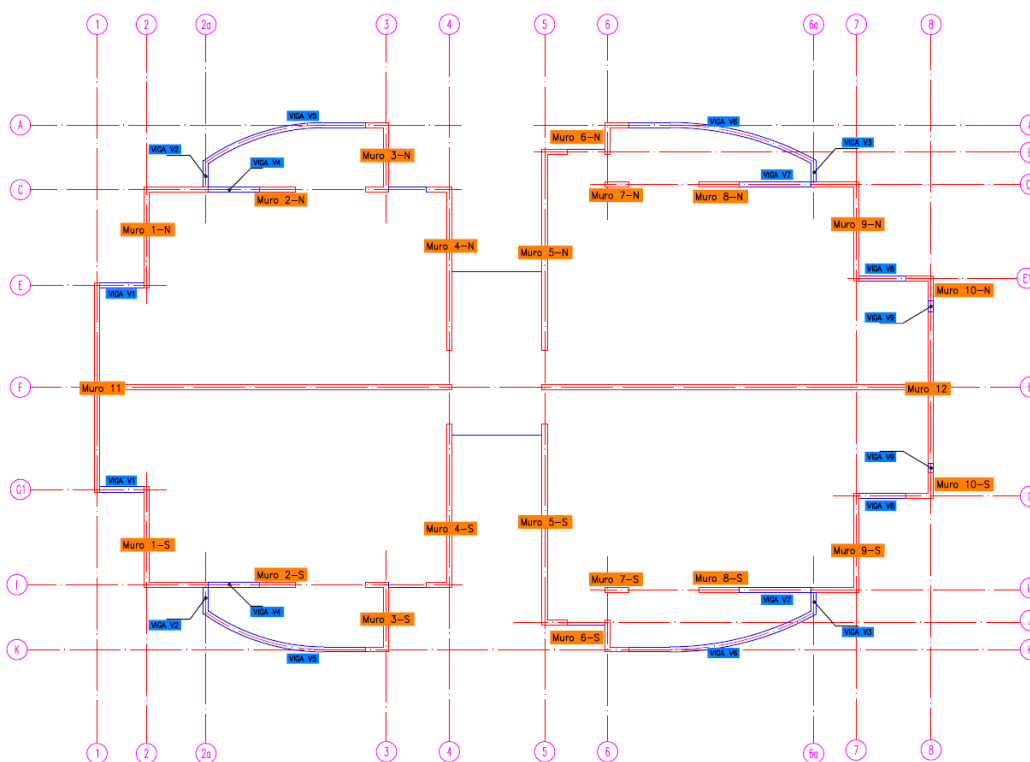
Etiquetado de elementos de diseño para muros y vigas en niveles intermedios.
